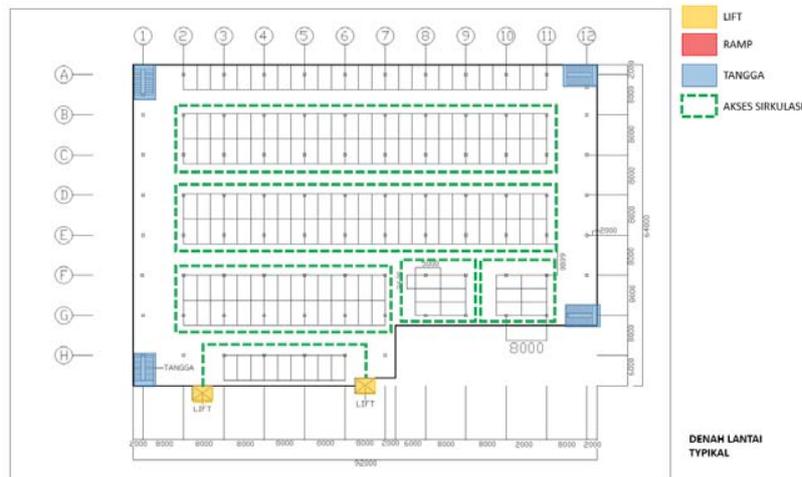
Zona Sirkulasi pada Denah Lantai Basement Pasar Kosambi
